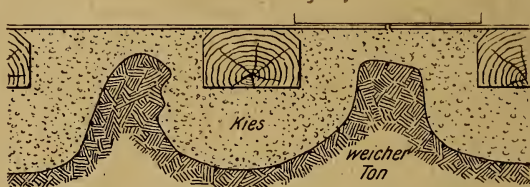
Auftrieb weichen Untergrundes, nach Schubert.
